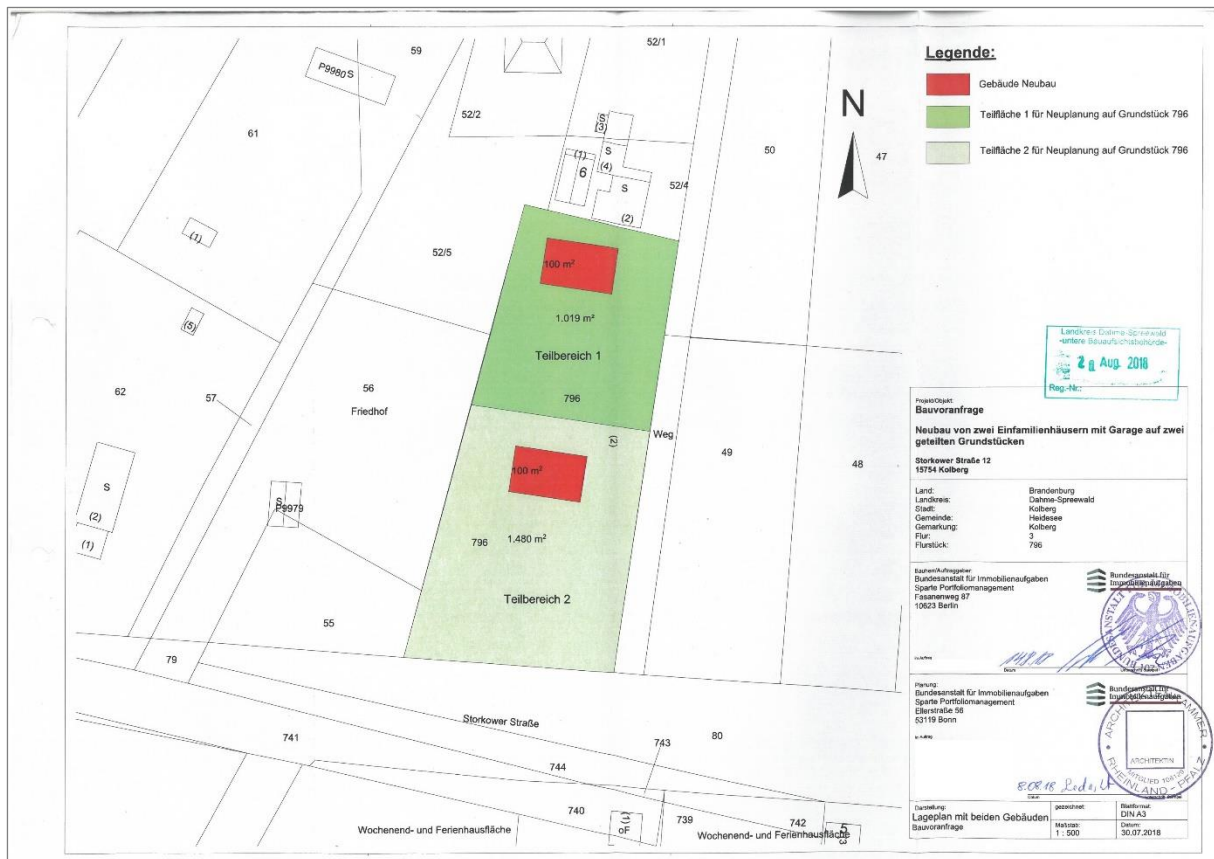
Anlage 1 zum Bauvorbescheid - Lageplan Teilfläche 2
